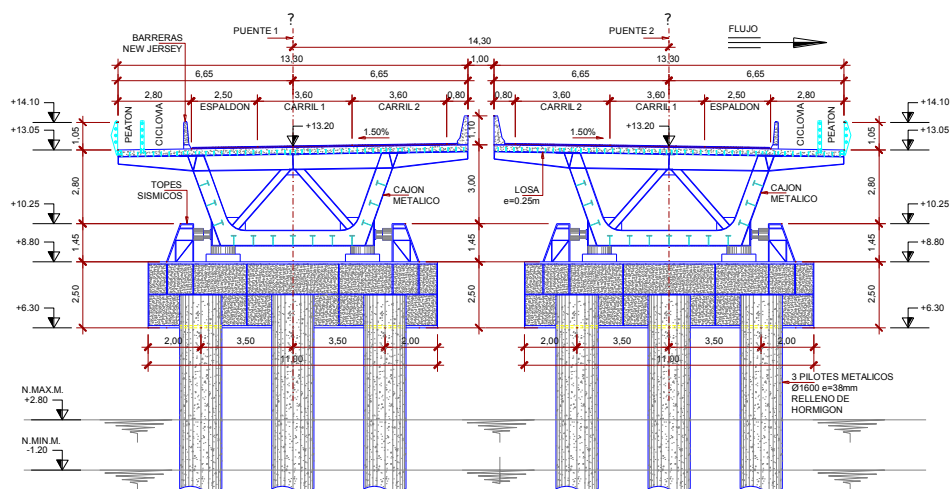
Corte transversal del puente Daule – Guayaquil (Fuente: Elaboración Propia)
